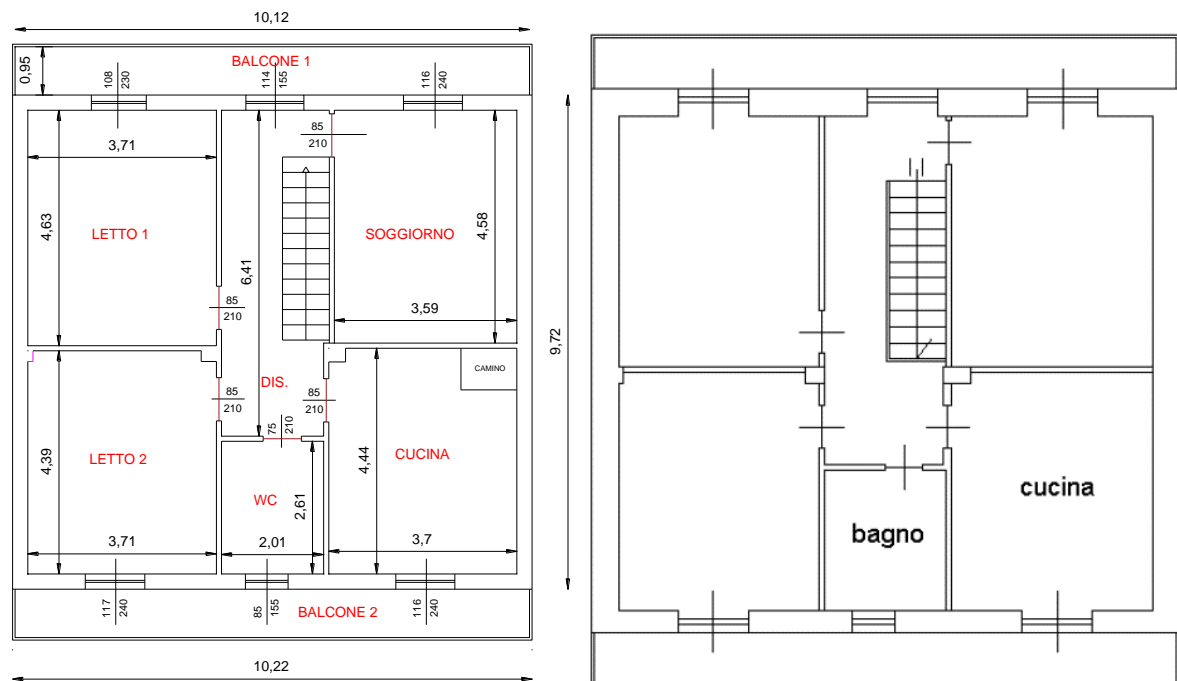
Raffronto planimetria da rilievo e planimetria catastale – PIANO PRIMO
